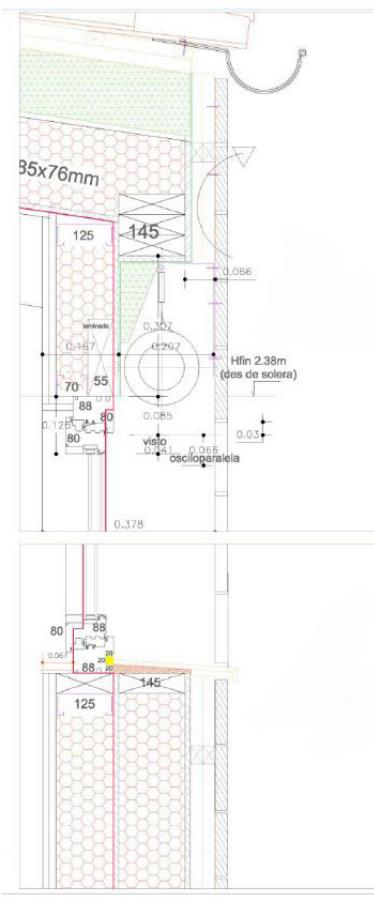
Detalle constructivo envolvente vertical, vivienda Passivpalau.
